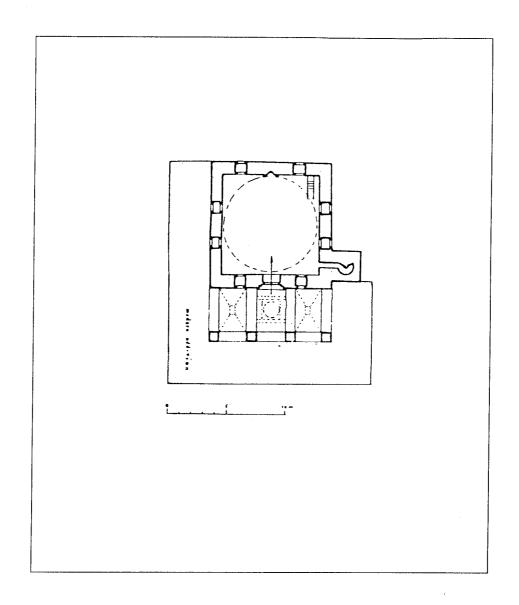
مسقط أفقي للمسجد القديم (اسكى جامع) في اسكى زغرا في بلغاريا (عن: كيل)
